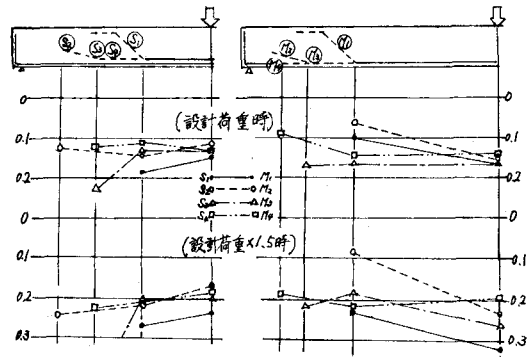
載荷時、設計断面、鉄筋切断時の最大ひびわれ幅(mm)
